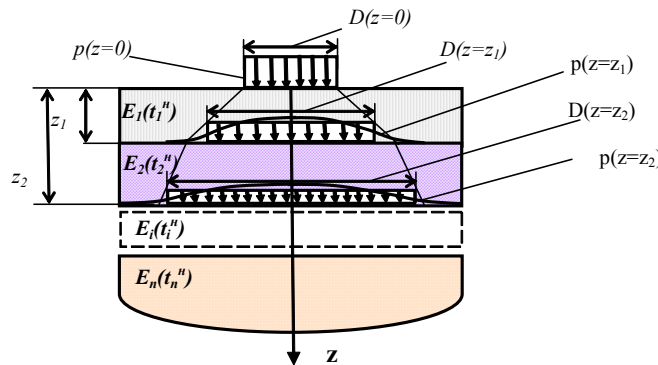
Расчетная схема для определения времени действия нагрузки от транспортных средств на асфальтобетонные слои дорожной одежды
